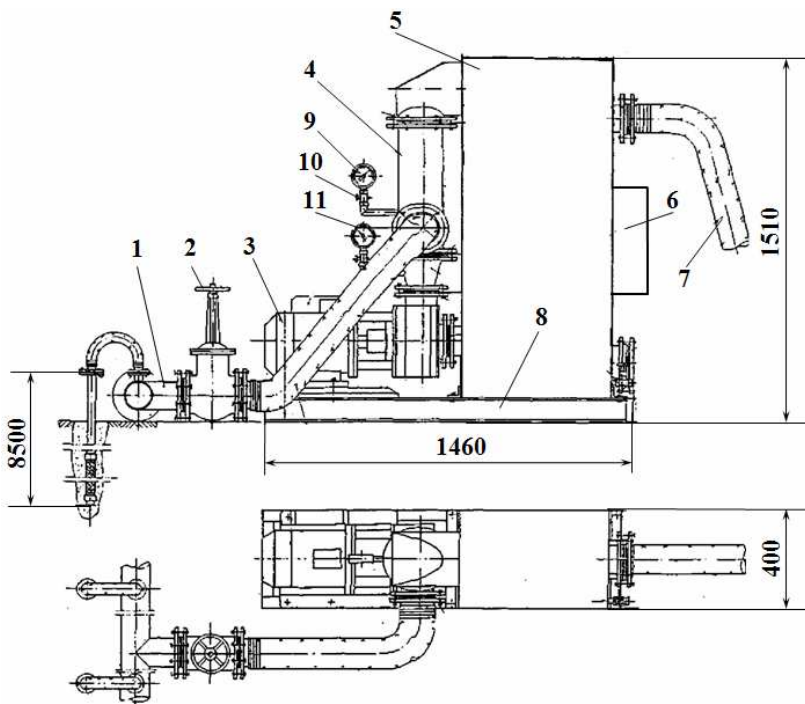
Универсальная установка локального вакуумного водопонижения ПУВВ-5 МЕ с регулируемым электроприводом: 1 – всасывающая система; 2 – задвижка; 3 – центробежный насосный агрегат; 4 – полиструйный насос ПНС-1; 5 – циркуляционный бак; 6 – шкаф электрический; 7 – сливная линия; 8 – рама; 9 – вакуумметр; 10 – трехходовой кран; 11 – манометр
